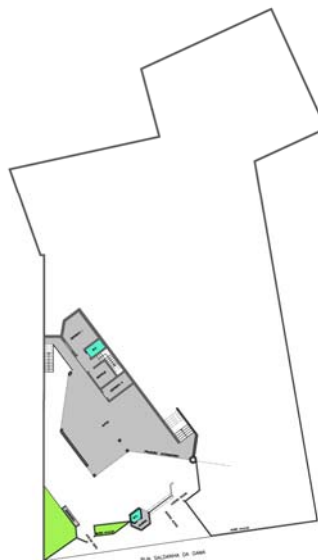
Planta digitalizada do pav. inferior – nível + 0,40 m(2006)
